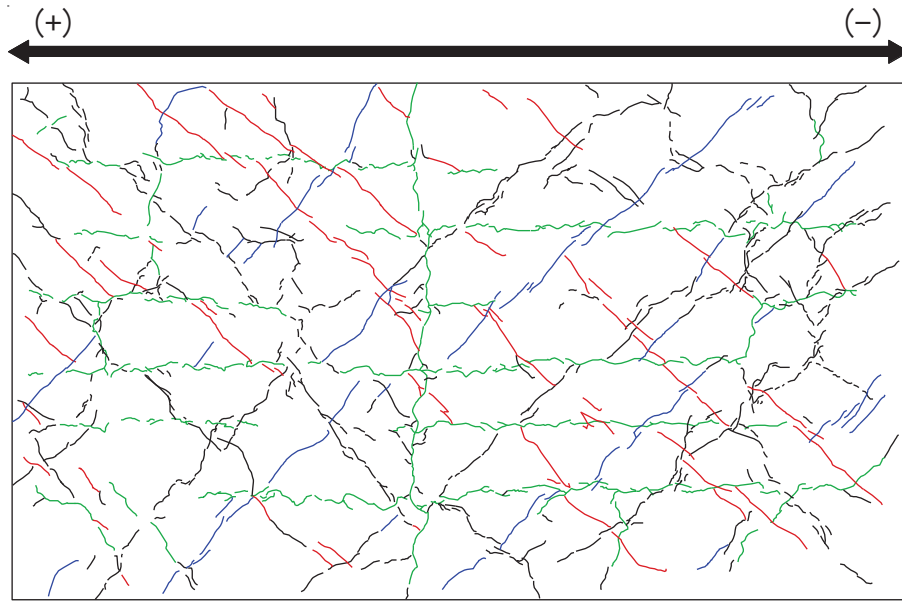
(9) 乾燥試験体 [1] 1/500rad. におけるひび割れ図
